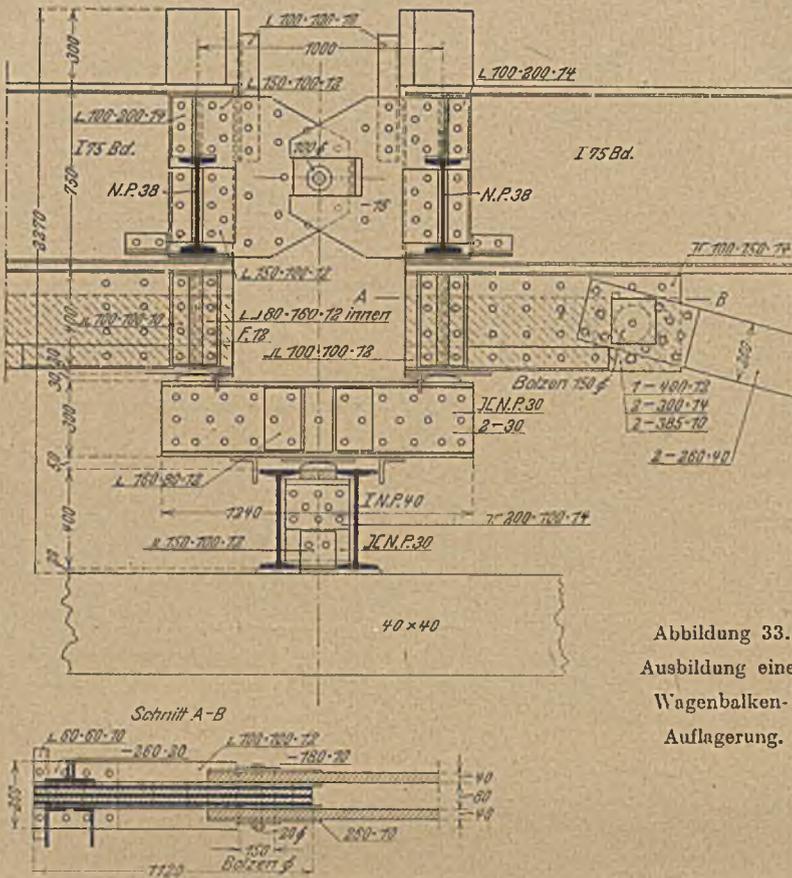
Ausbildung einer Wagenbalken-Auflagerung.
